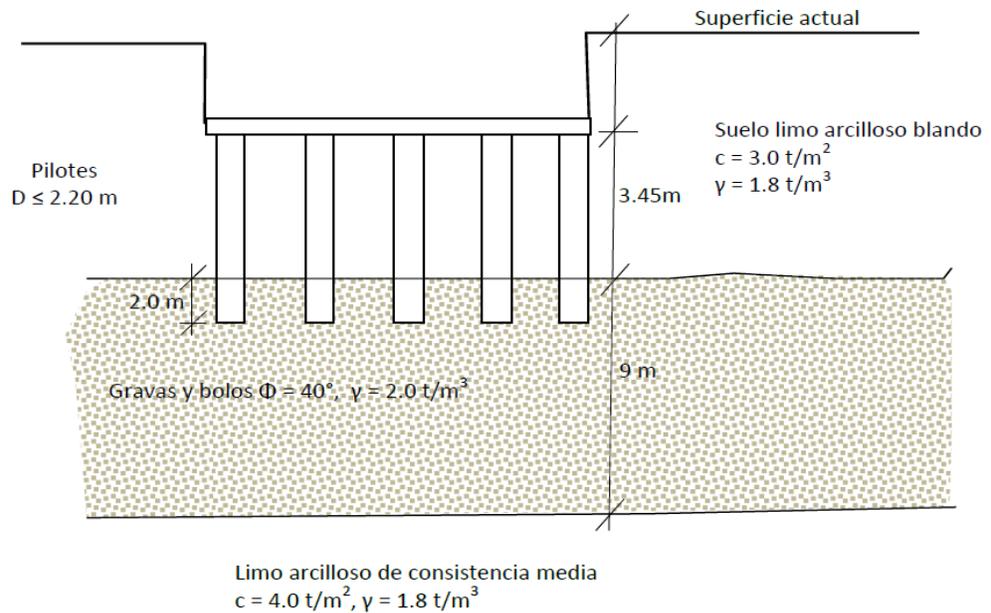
Cimentación con pilotes de 2.2 m de diametro y 5.45 m de longitud.
